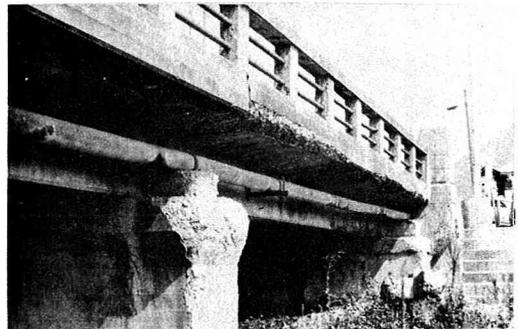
は、津軽半島の河口に近い所の道路橋の桁の凍害状況である。この橋のコンクリートに使用した骨材は大部分が吸水性の著しく大きなもので、コンクリートの品質も特に劣っていたものと思われる。荷重による曲げひびわれが発生した部分に、雪の付着および波しぶきがかかり、また冬の季節風の影響でコンクリート構造物の温度低下がはげしいなど、凍害をうけやすい条件が重なり、かぶりのコンクリートが大きく剥落して鉄筋が腐蝕し、橋はきわめて危険な状態にある。
